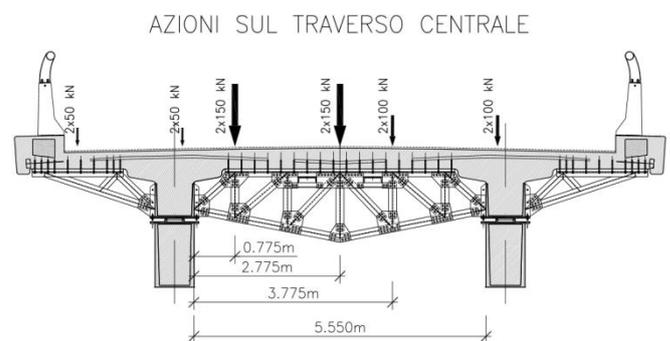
Particular of metal transversal beam)/particolare del traverso metallico.
